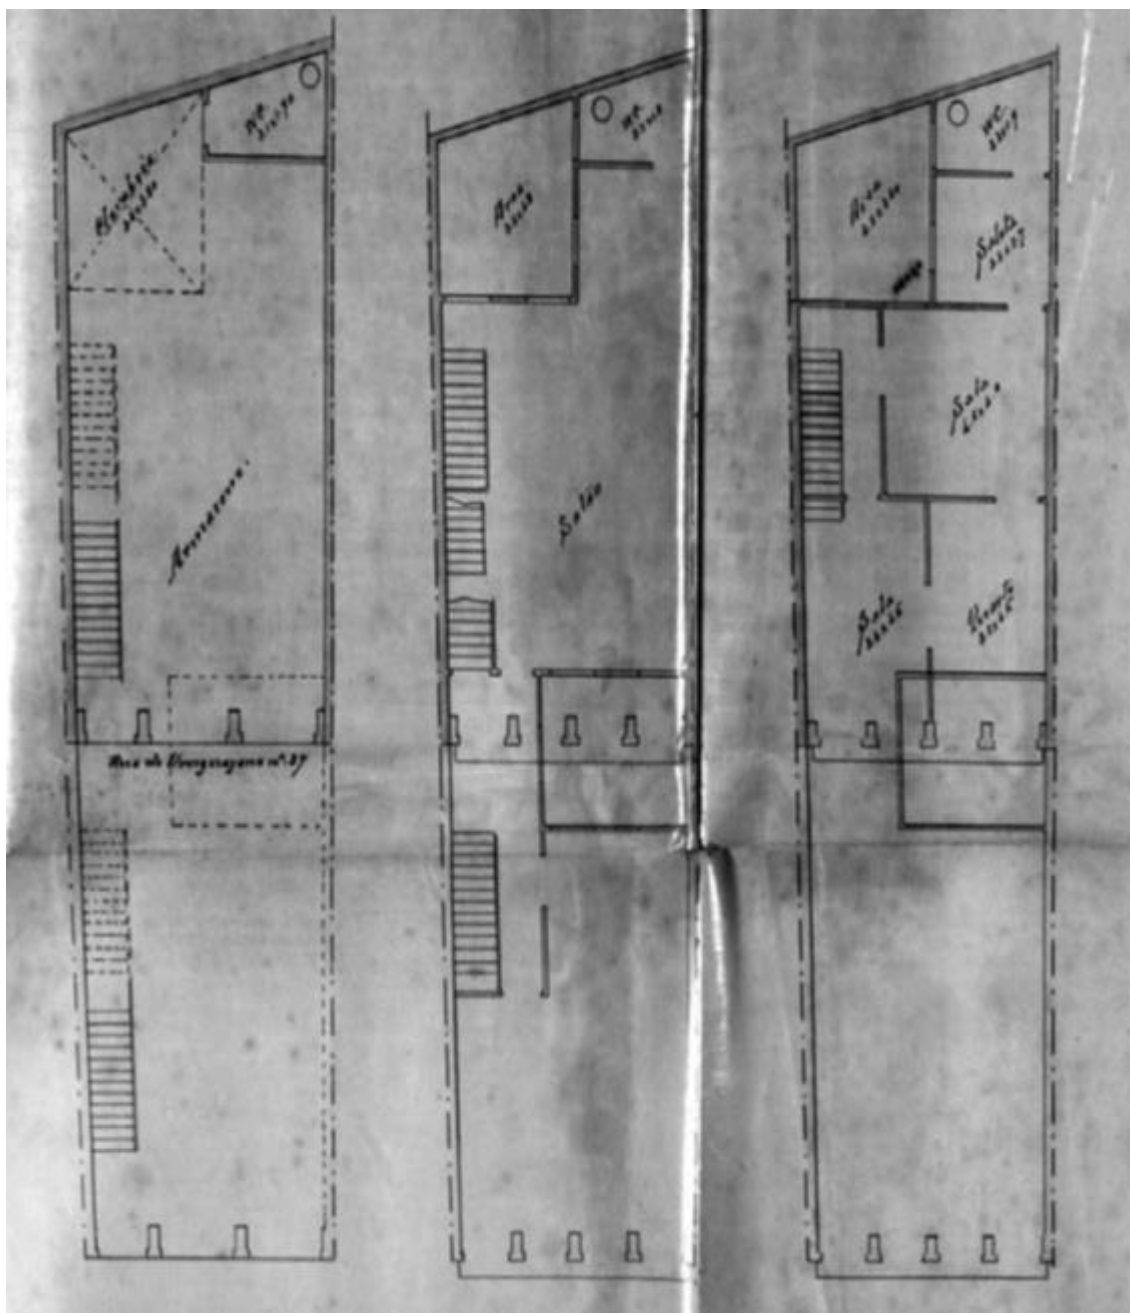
Planta baixa dos três pavimentos da edificação situada a Av. Uruguiana
